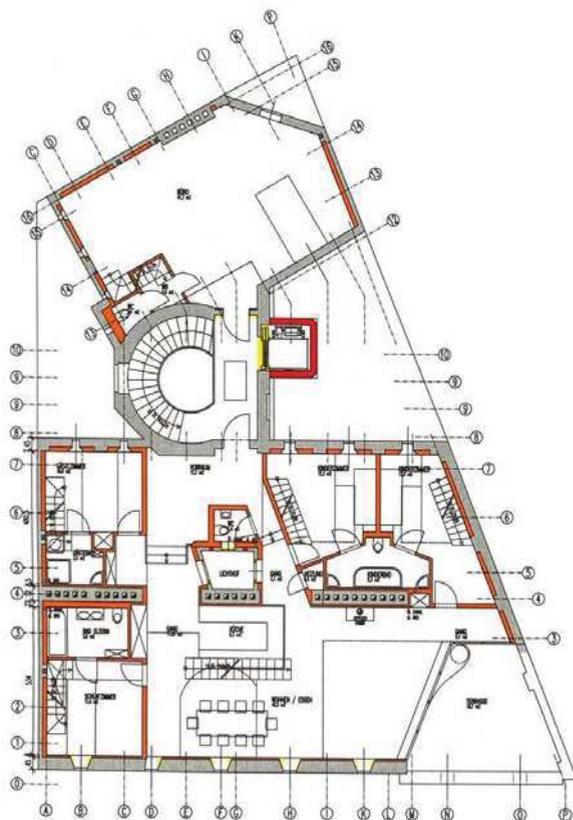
Grundriss Dachgeschoss Günthergasse 2, Wien
